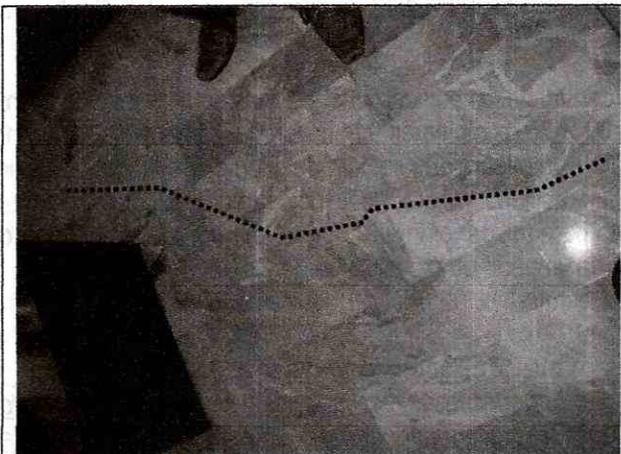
Fisuras típicas en pisos de las viviendas que se localizan en la zona central del bloque nororiental del Conjunto Residencial Cataluña.
